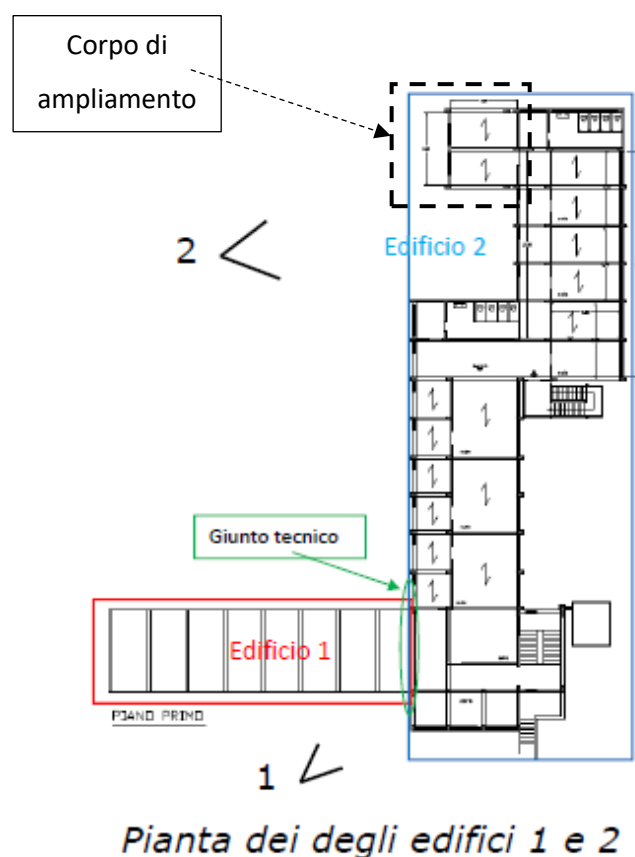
Organizzazione in pianta del complesso "Parozzani" [11].
